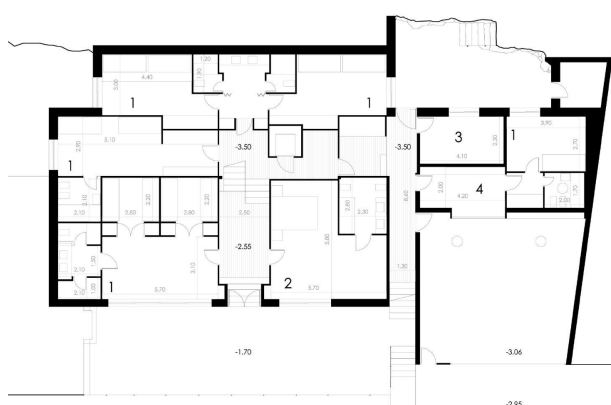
Planta -1, semienterrada. Fuente: ver cita 17
